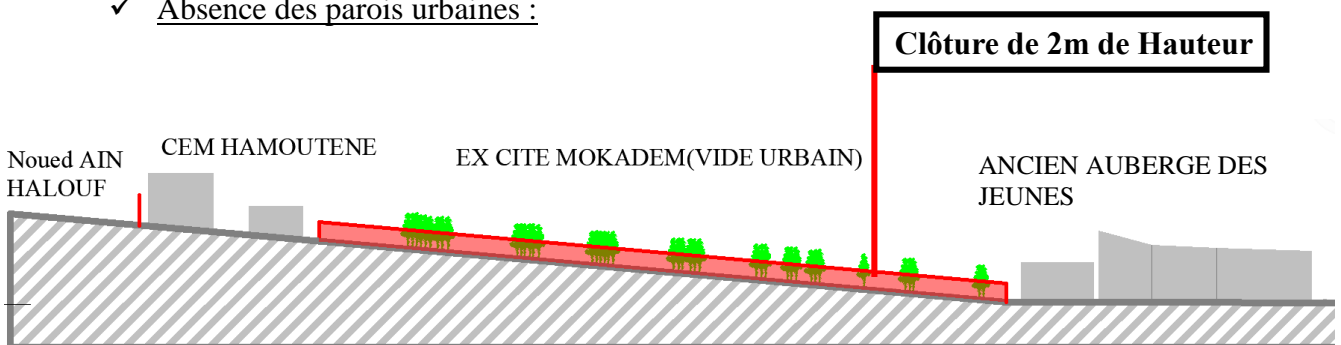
Coupe schématique longitudinale (Profil) sur la rue KESRI.
